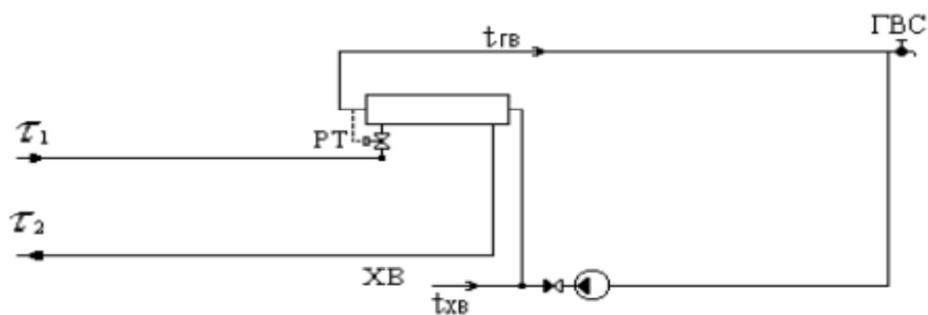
Схема № 27 - Потребитель с подогревателями ГВС
